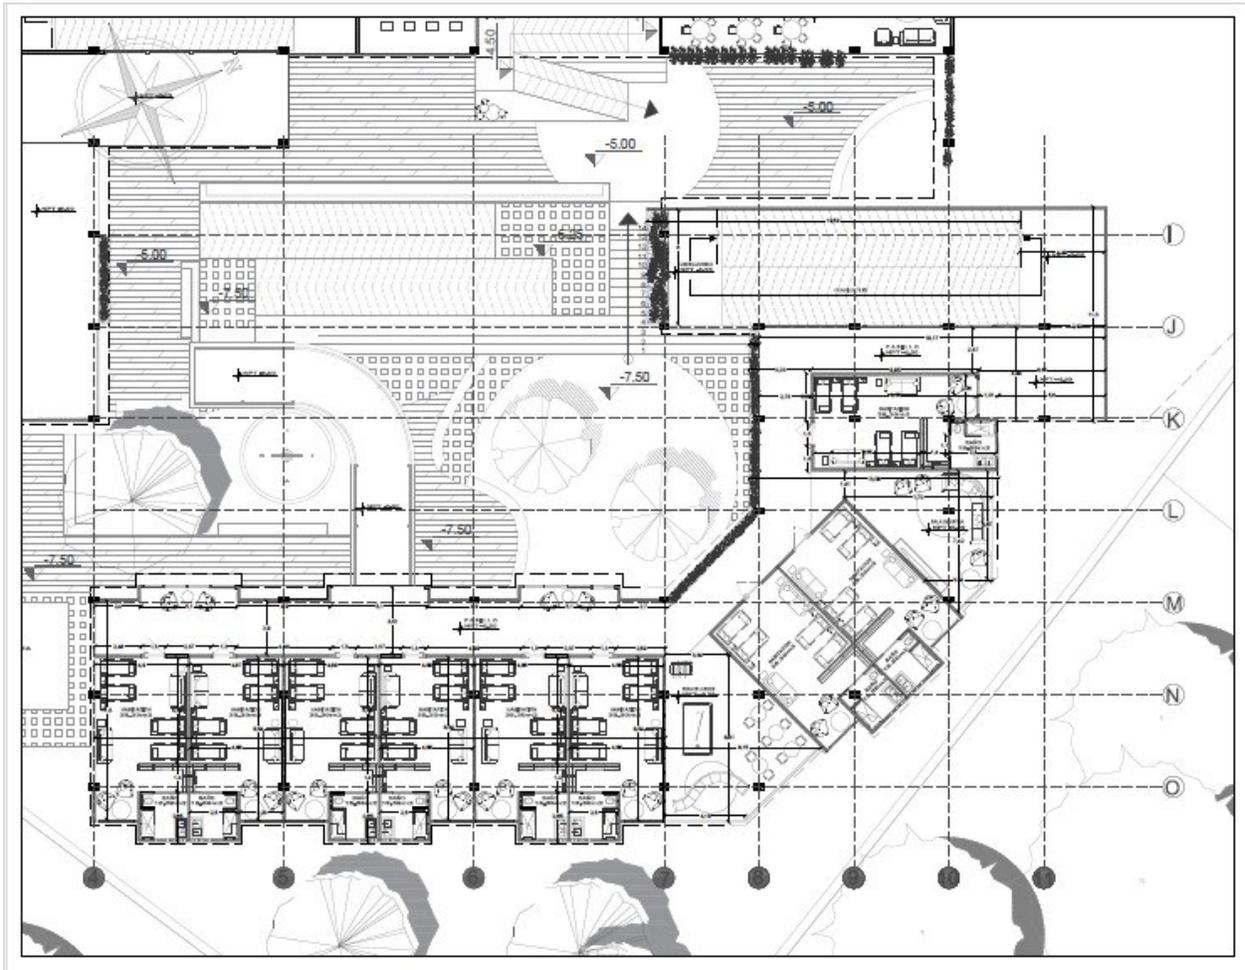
Planta -1 Edificación 3 (Rubiano, 2020)
